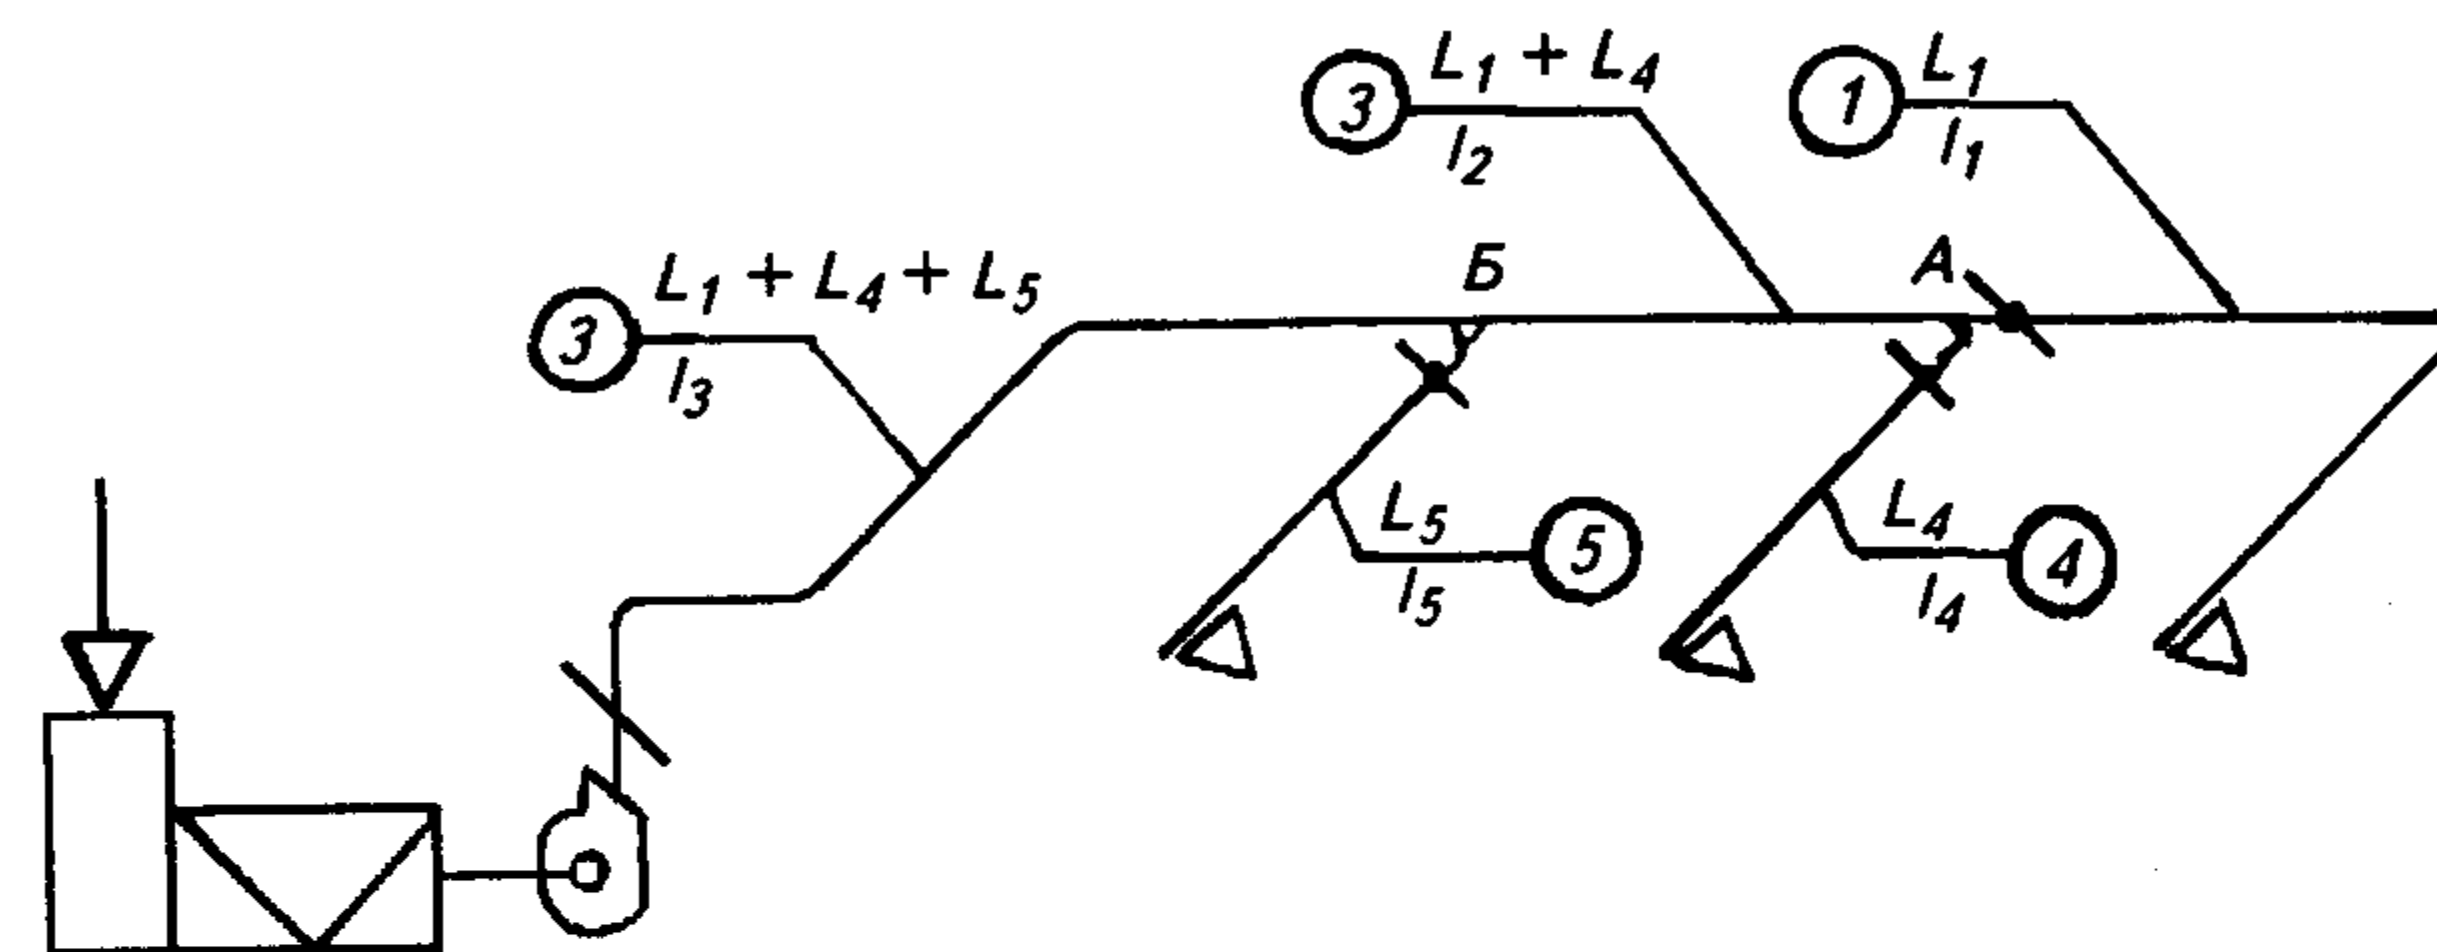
Аксонометрическая схема системы вентиляции:
